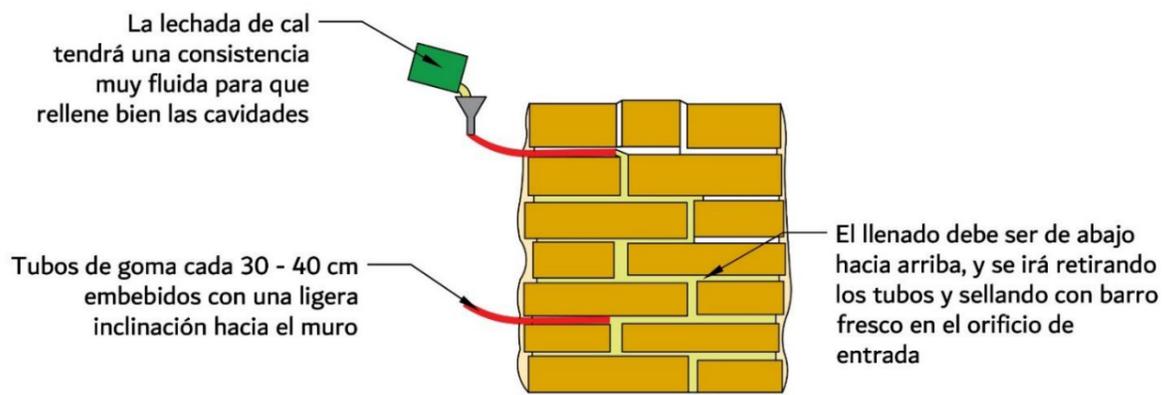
Detalle de consolidación de muros. Fuente Luis Segovia 2023
